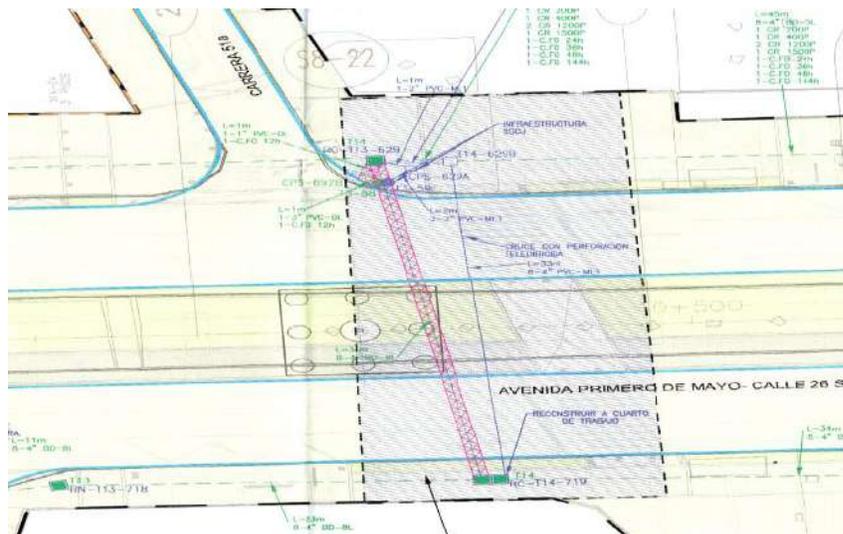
Plano de localización general de la red ETB3-16
